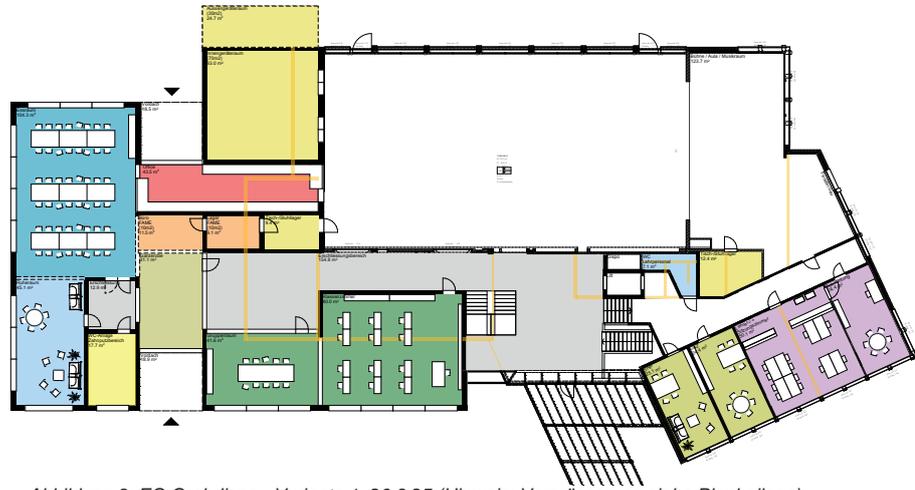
EG Grobdispo - Variante 1, 26.3.25 (Hinweis: Vergrößerung siehe Planbeilage)
